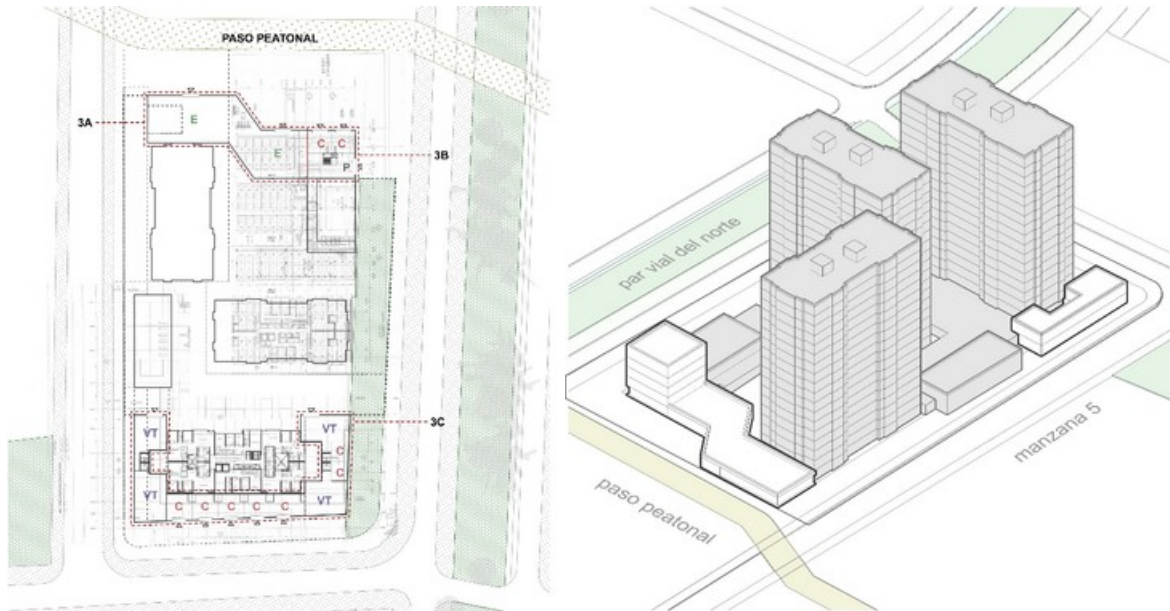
Planta y axonometría de la propuesta desarrollada para la Manzana 3.
